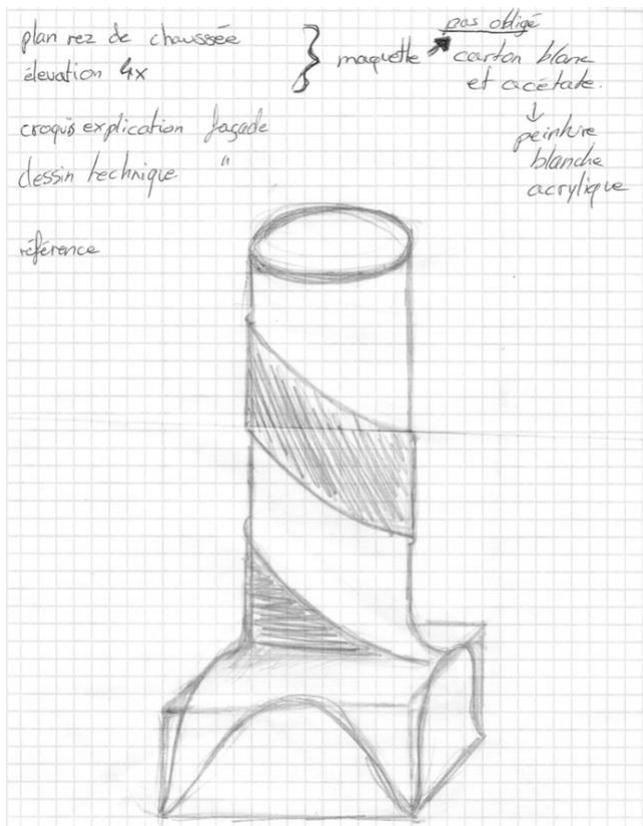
et 18 : Sketch de la tour (avec panneaux solaires).
